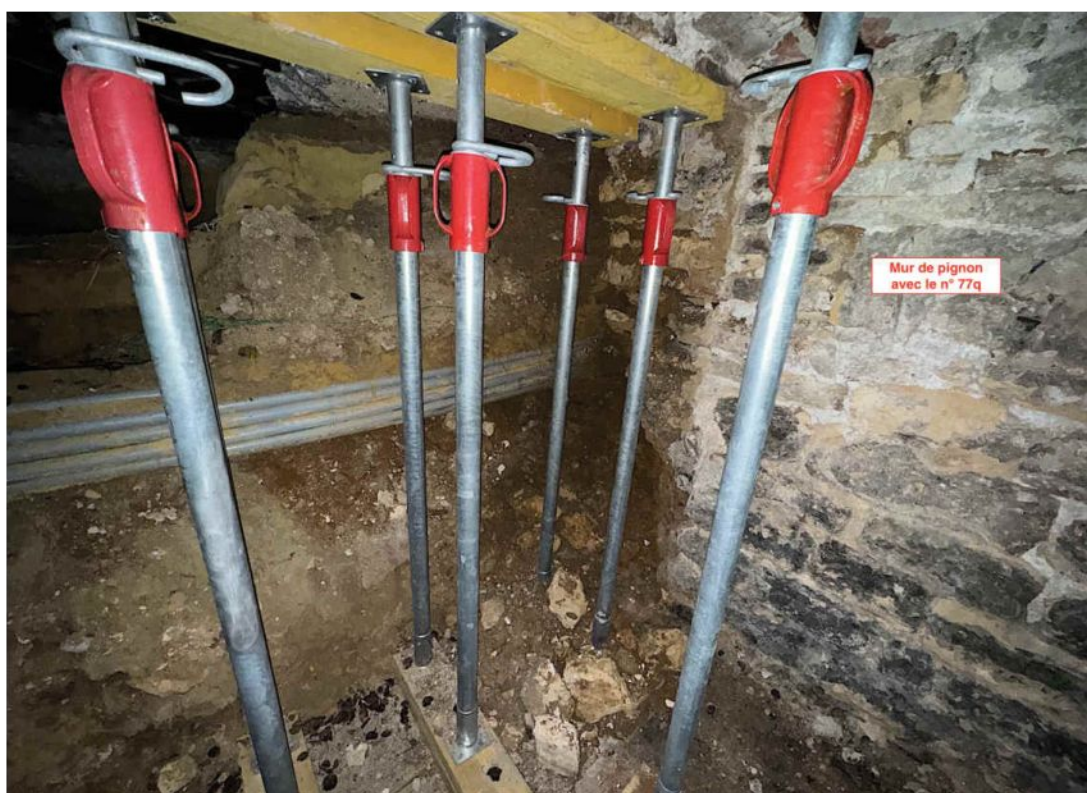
Visuels de l'effondrement en cave et étaieiment provisoire
